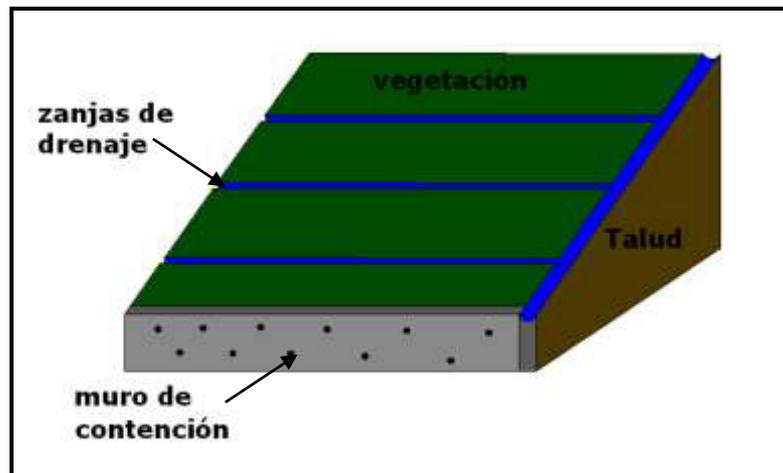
Perfil Esquemático de una Zanja de Drenaje y Muro de Contención.
